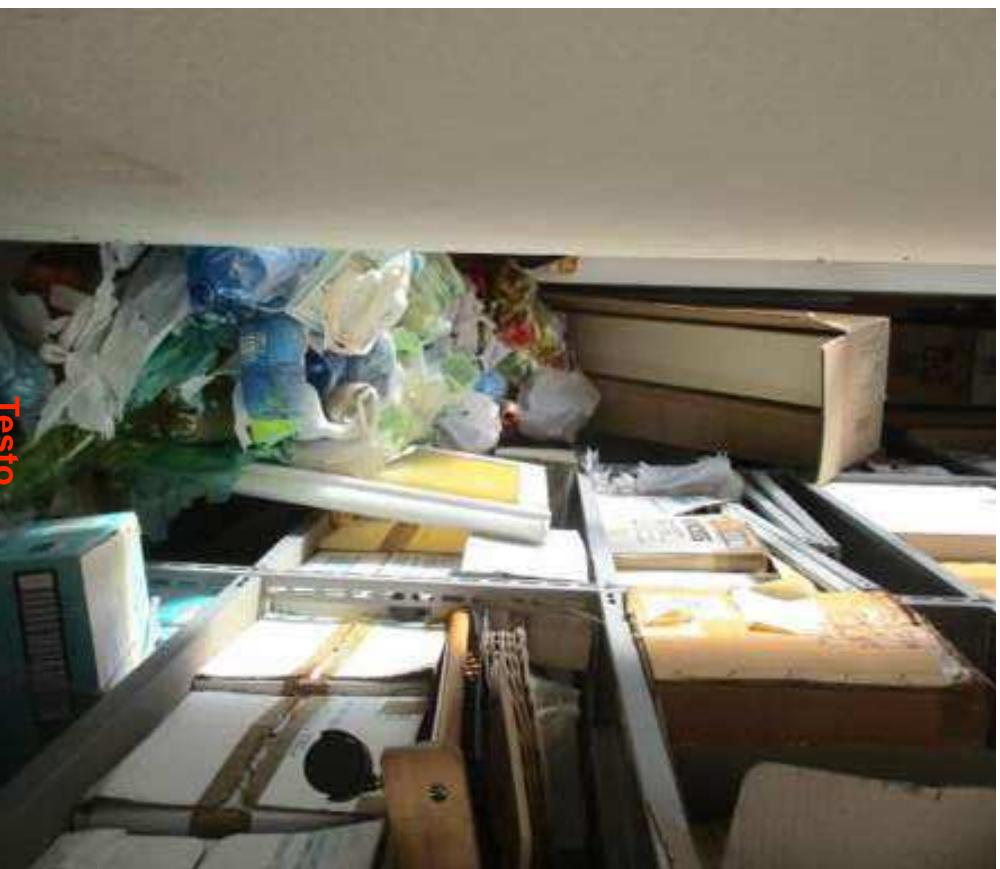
particolare del soffitto di una camera dell'appartamento
